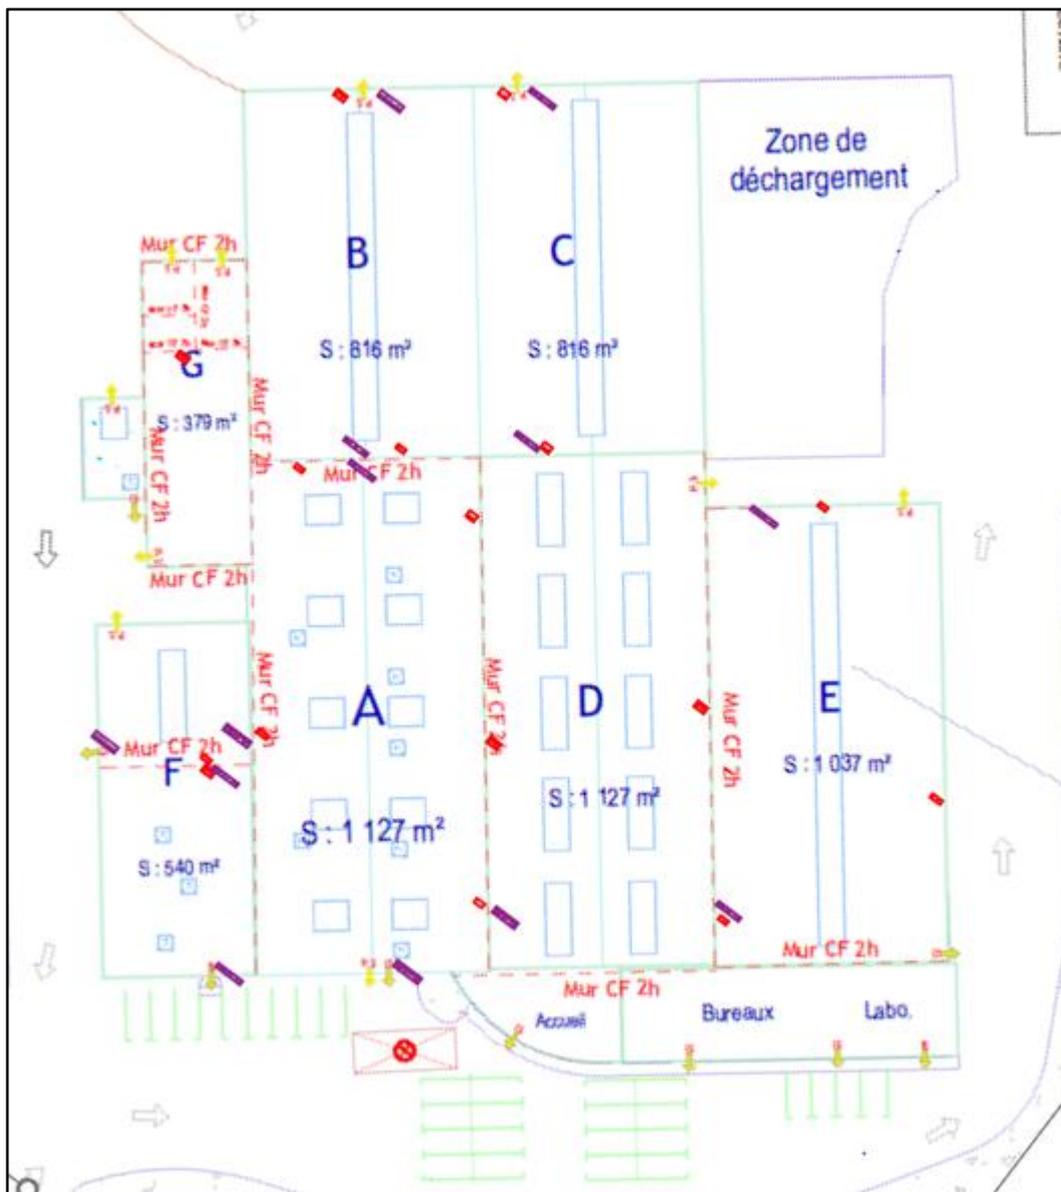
Localisation des murs coupe-feu bâtiment existant (source : sicabconstruction)
